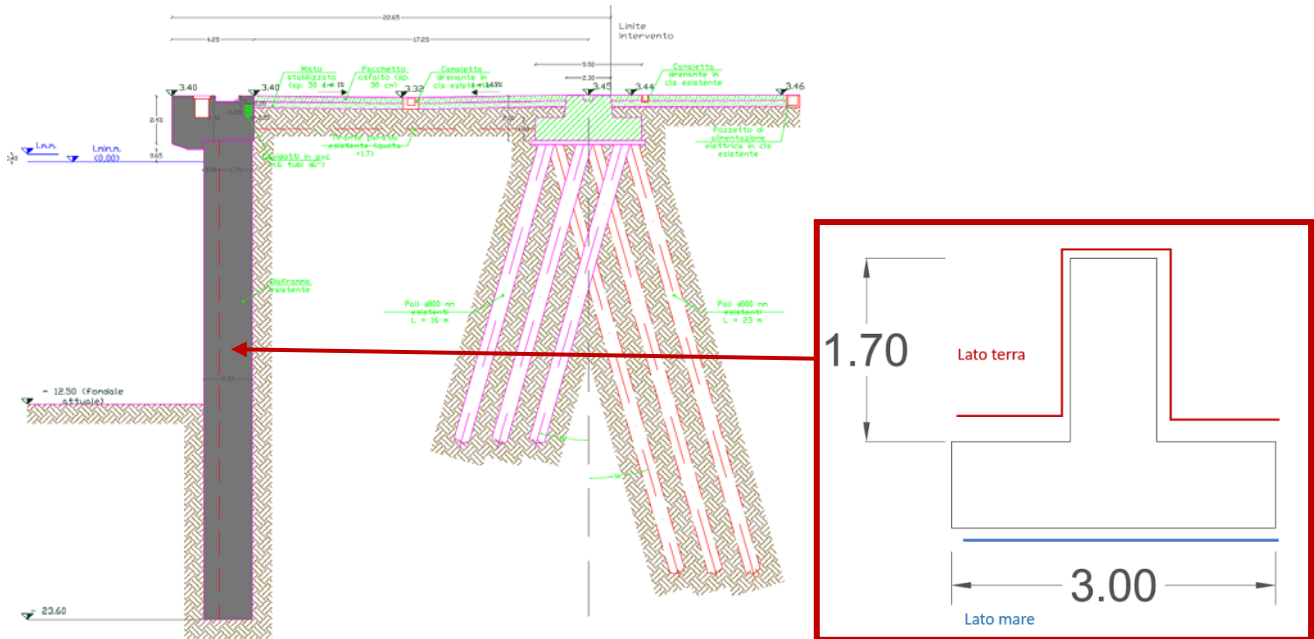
sezione della banchina esistente e geometria dei diaframmi
